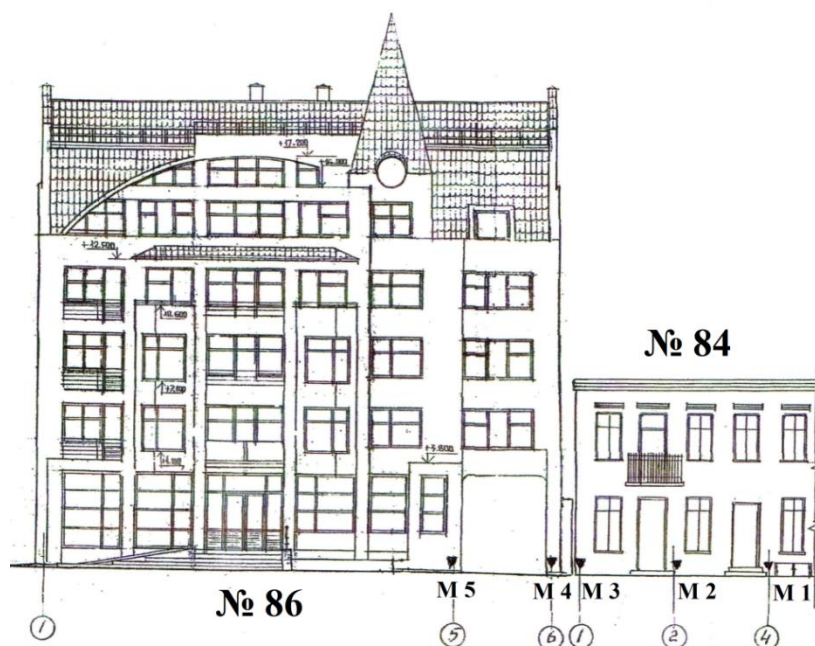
Розташування стінних марок на фасадах сусідніх будівель.
